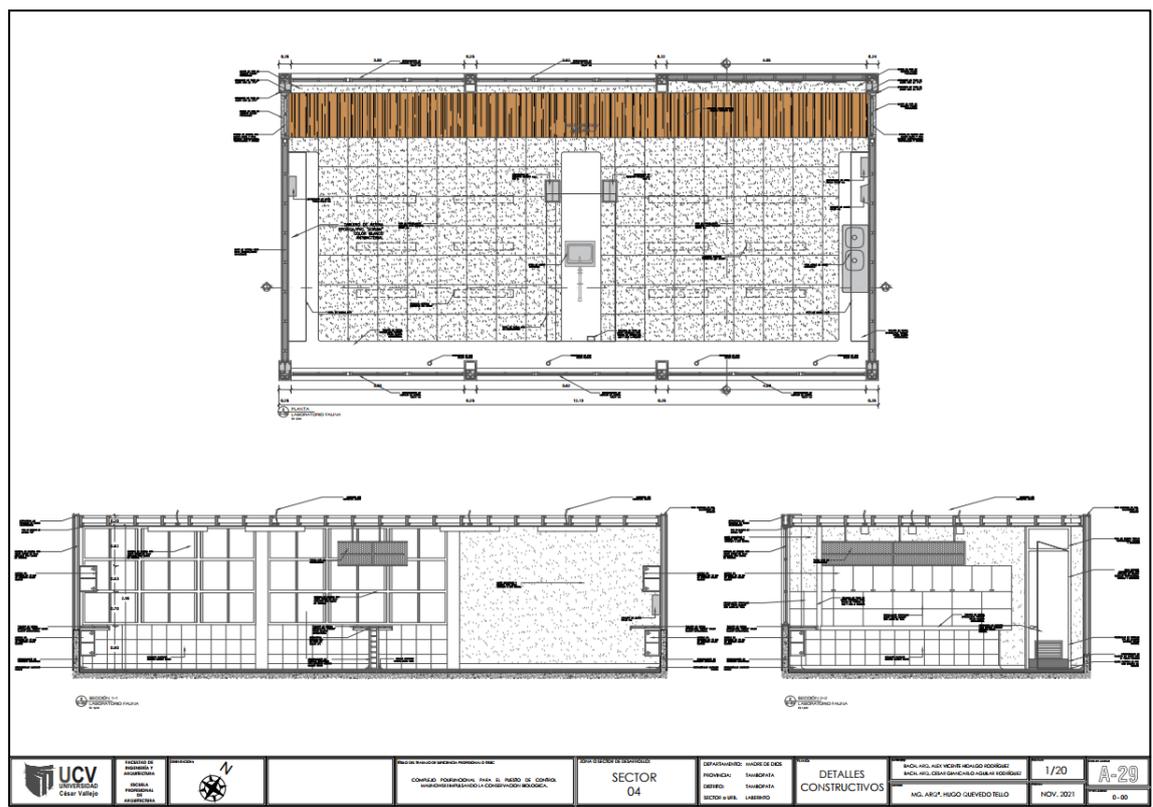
Detalle arquitectónico, Muro Entablado, Columna viga y Columna junta seca.
